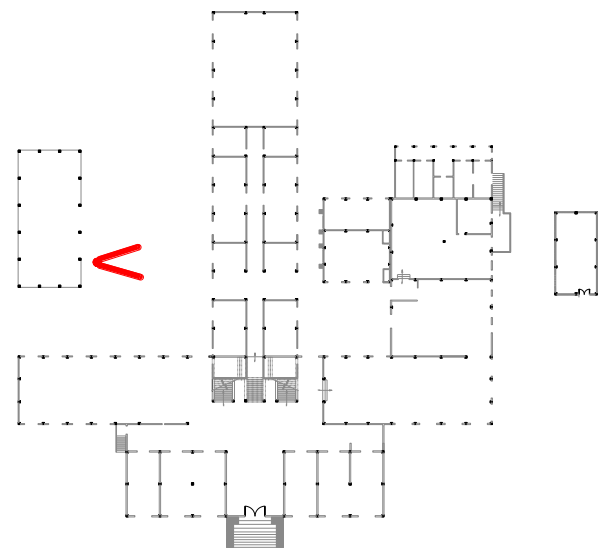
Vista espacio exterior cubierto, circulación, plaza
